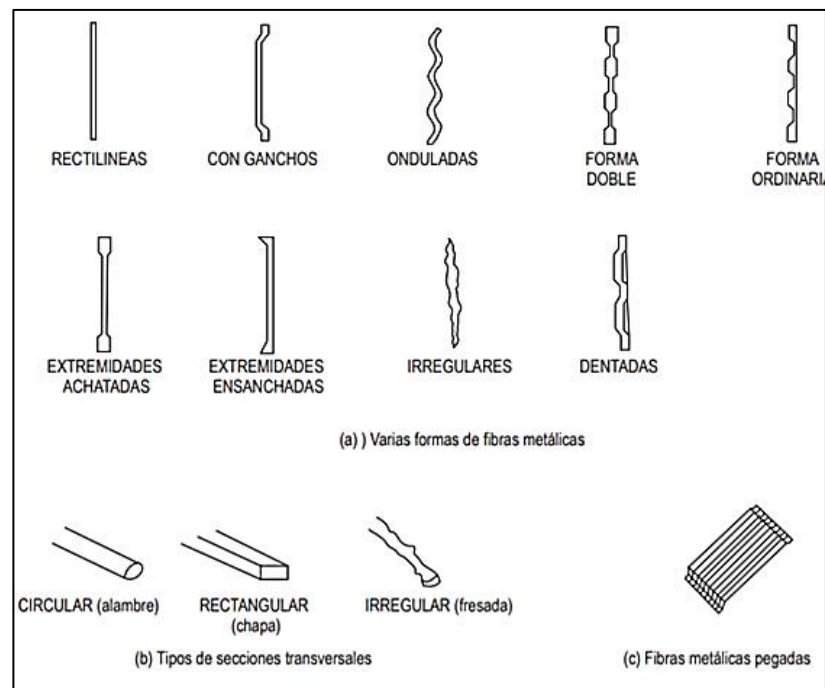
Tipos de Fibras Metálicas Según su Sección transversal. Tomada del Manual Técnico de Fibras Como Elemento Estructural Para el Refuerzo del Concreto, Maccaferri, 2015.
